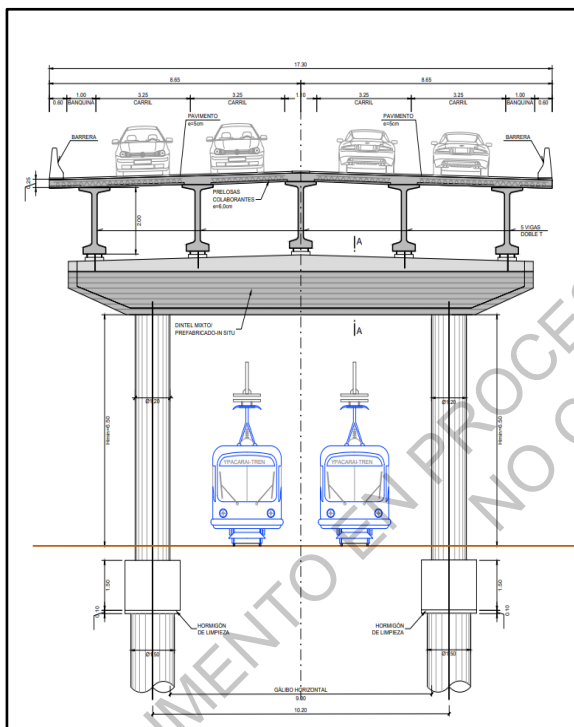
Sección tipo – Estructura PK 27+115 al PK 30+449
